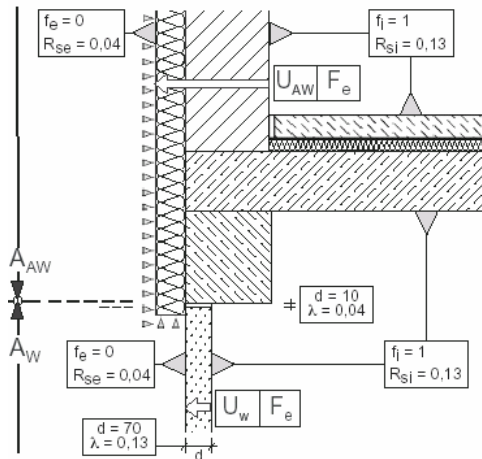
Fenstersturz - monolithisches Mauerwerk	Bemerkungen:
